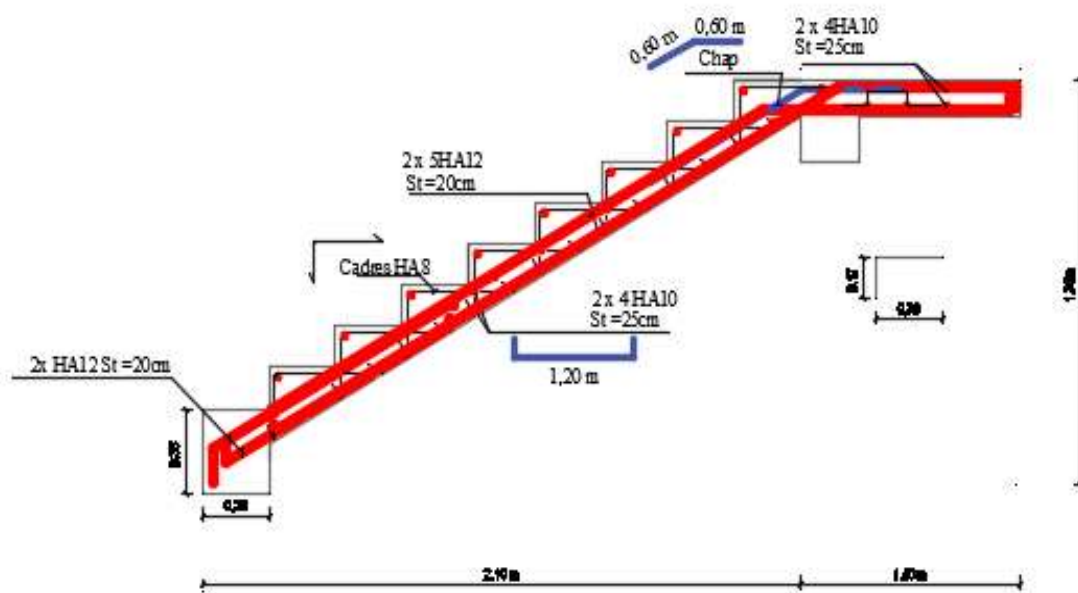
Plan de ferrailage de l'escalier de l'entre sol
